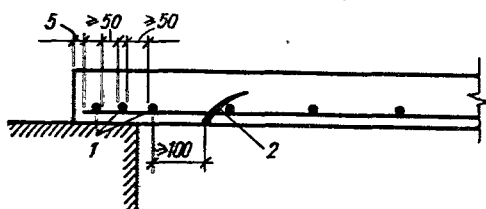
Анкеровка растянутых стержней арматуры на опорах плит из ячеистого бетона:
